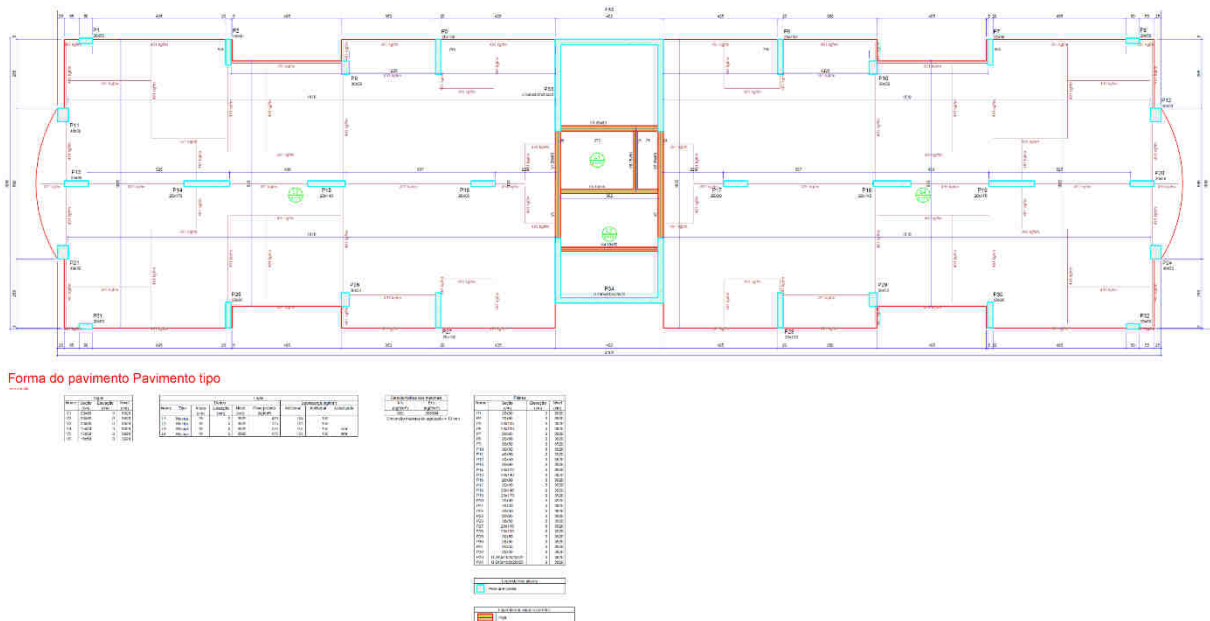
croqui do pavimento tipo gerada pelo programa Eberick – Modelo 5 – Lajes Lisas adaptado – classe do concreto C-50
